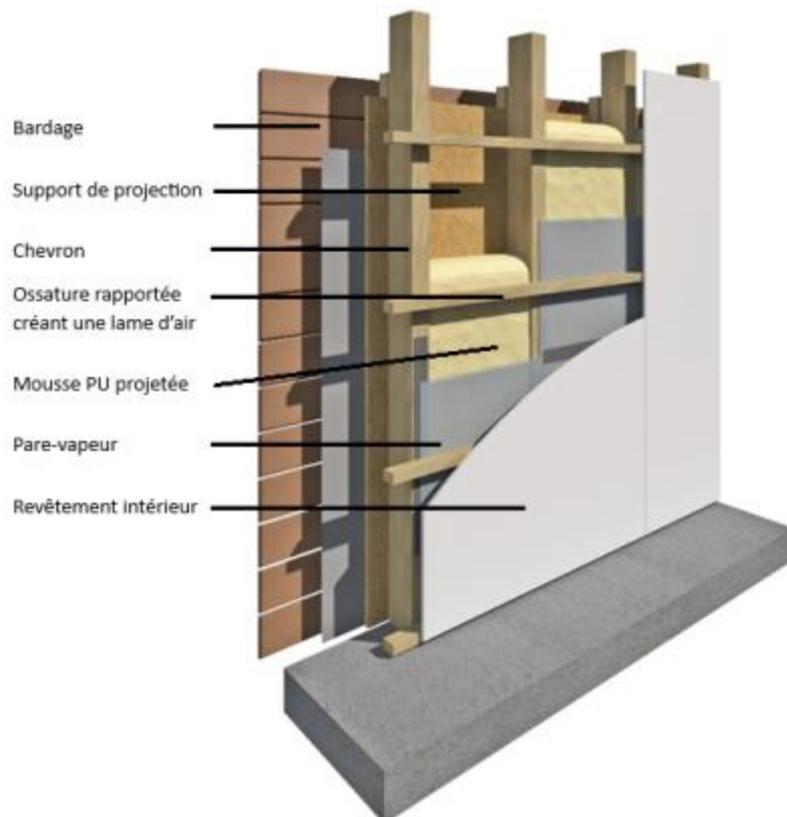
Système constructif entre montants en bois et pose du pare-vapeur avec espace technique, non autorisé dans les ERP
